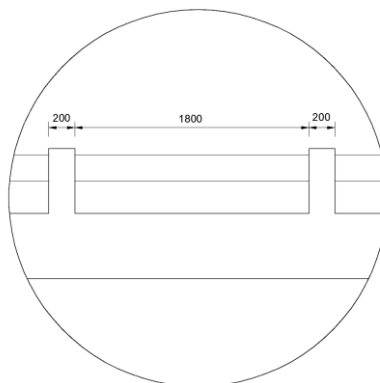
Dimensiones de las Barandas del puente Sección Longitudinal.
